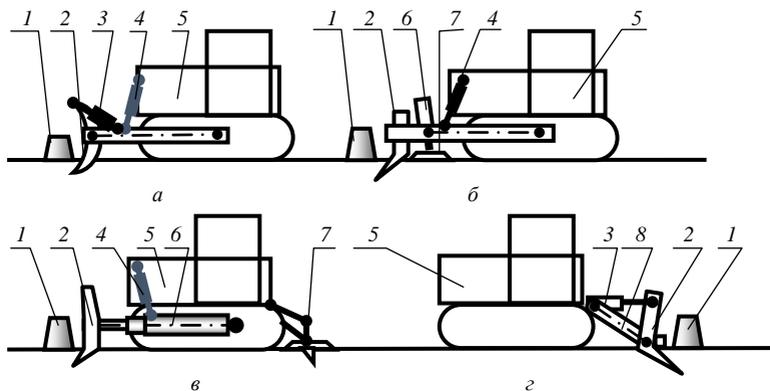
Основные схемы корчевателей: *а* – с комбинированным перемещением рабочего органа; *б* – с корчующей плитой; *в* – с телескопической толкающей рамой; *з* – рычажный корчеватель: 1 – пень; 2 – рабочий орган; 3 – гидроцилиндры поворота рабочего органа; 4 – гидроцилиндры подъема рабочего органа; 5 – трактор базовый; 6 – гидроцилиндр телескопический; 7 – устройство якорное; 8 – рама подъемная
